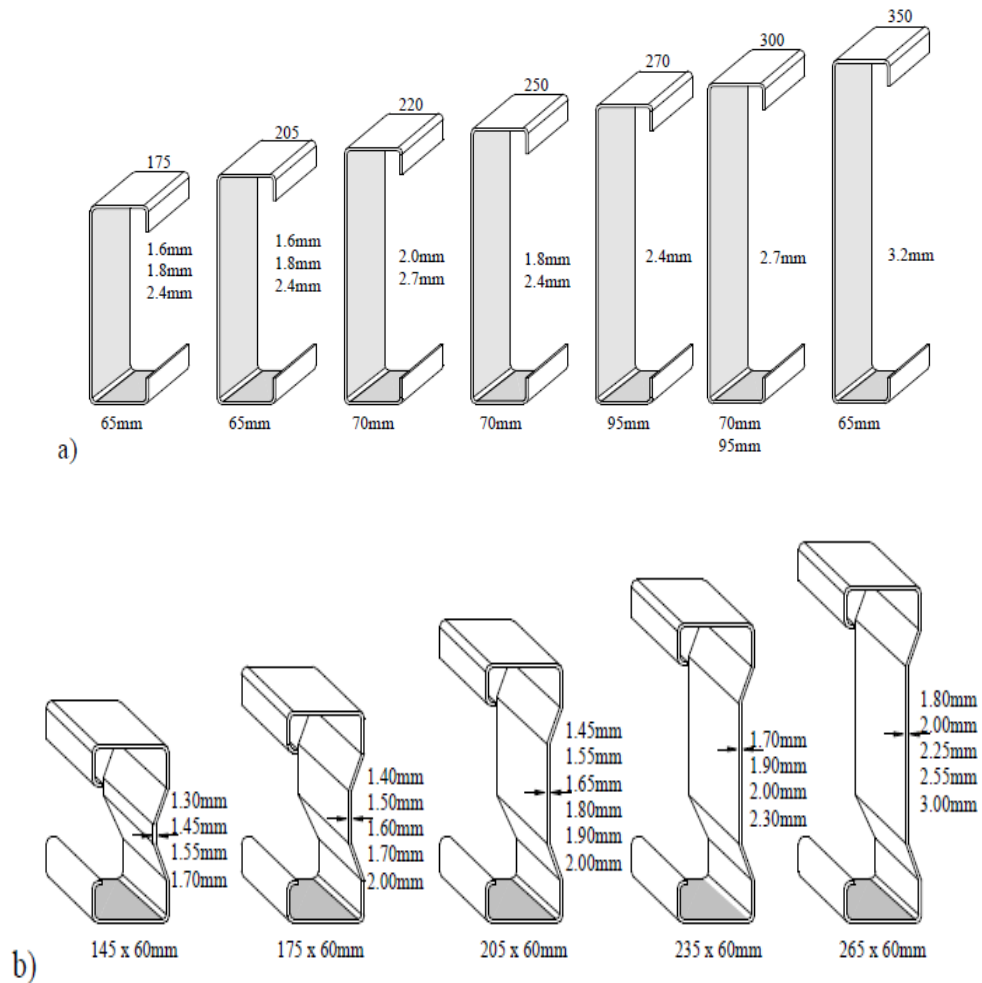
Types des poutres a) sections en C ; b) sections en  $\Sigma$
